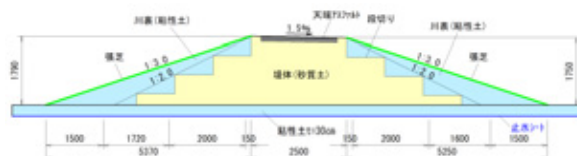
試験堤防横断面図 (試験堤防 No. 1)
